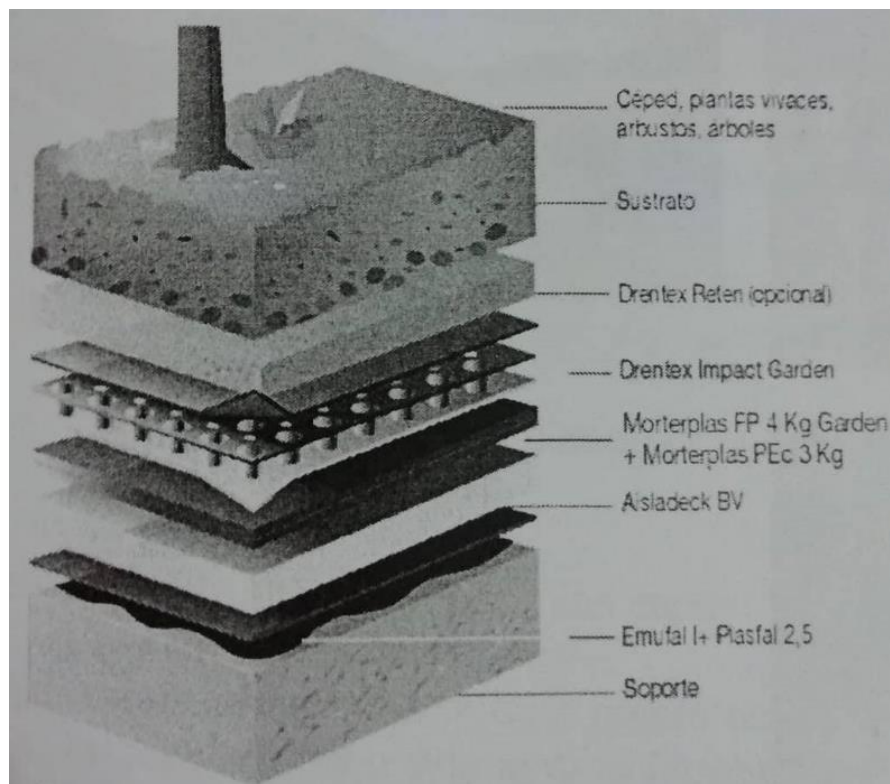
Detalle constructivo de las cubiertas ajardinadas intensivas.
